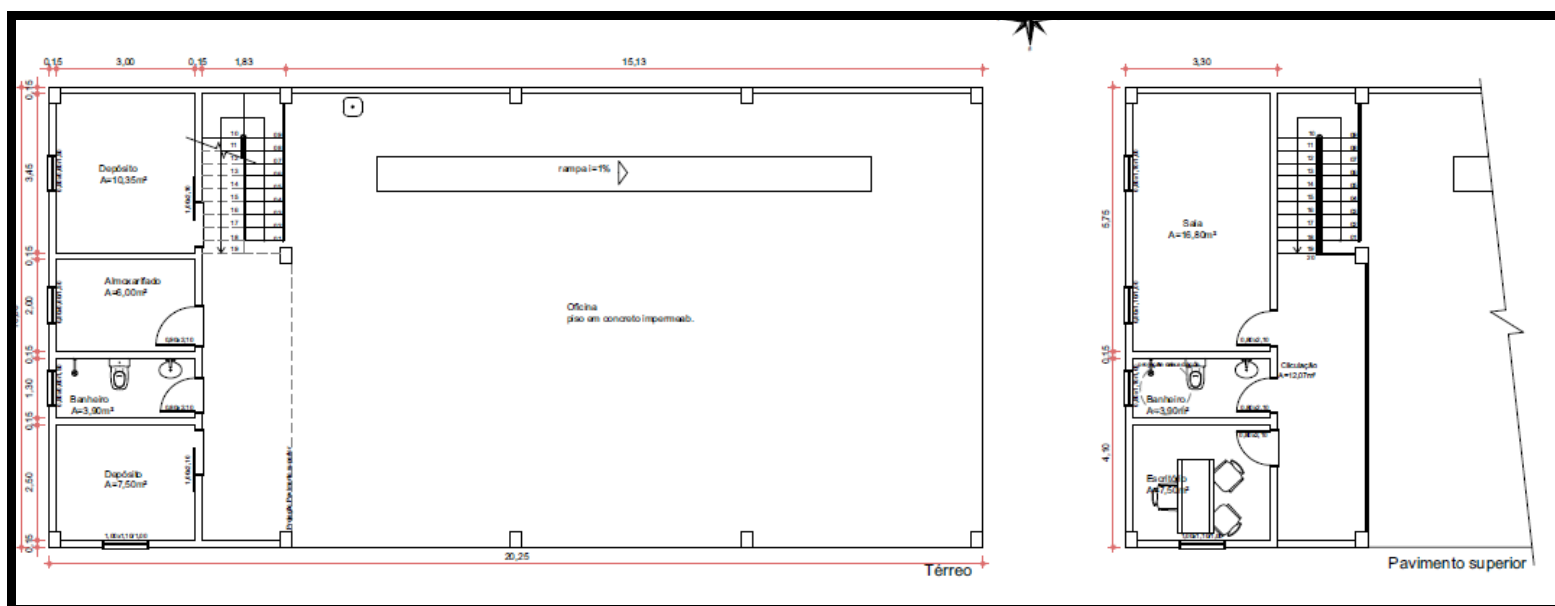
ilustração da planta baixa do empreendimento. Fonte: projeto arquitetônico.
